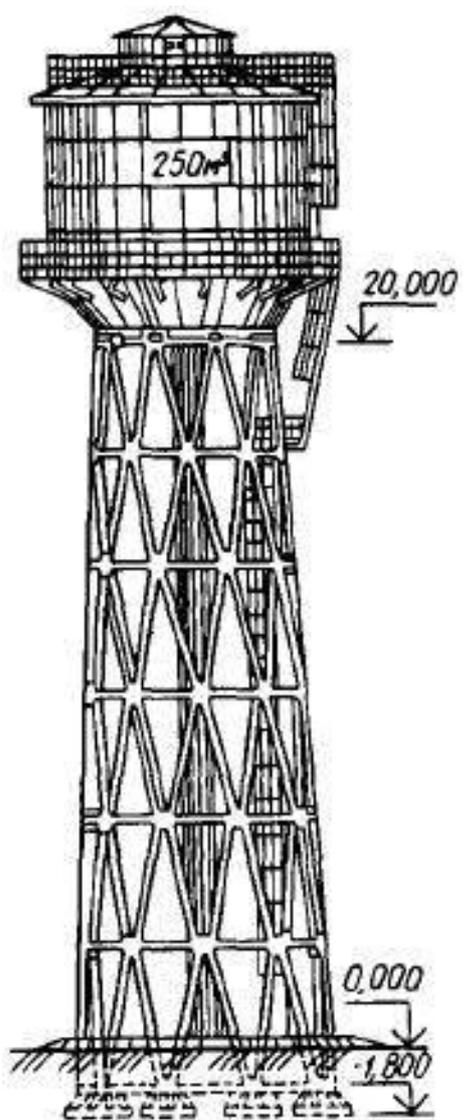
Железобетонная водонапорная башня с крестово-сетчатой опорой из сборных элементов
